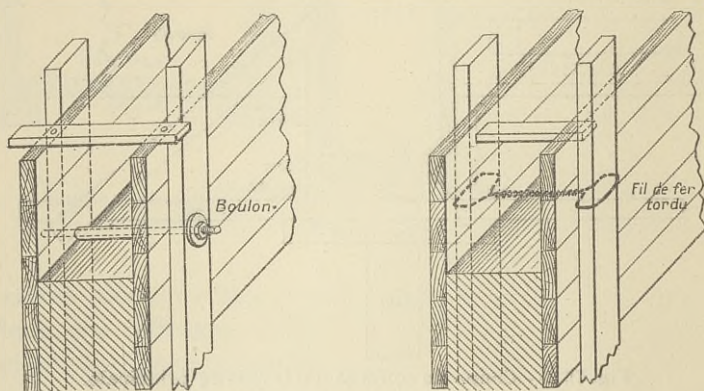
Coffrage pour mur avec boulon. Fig. 78. — Coffrage pour mur avec fil de fer.
